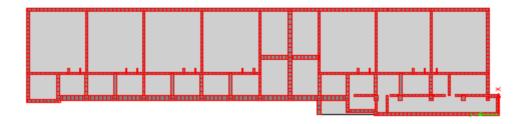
Planta primer piso, Colegio Madres Domínicas Edificio 2.
